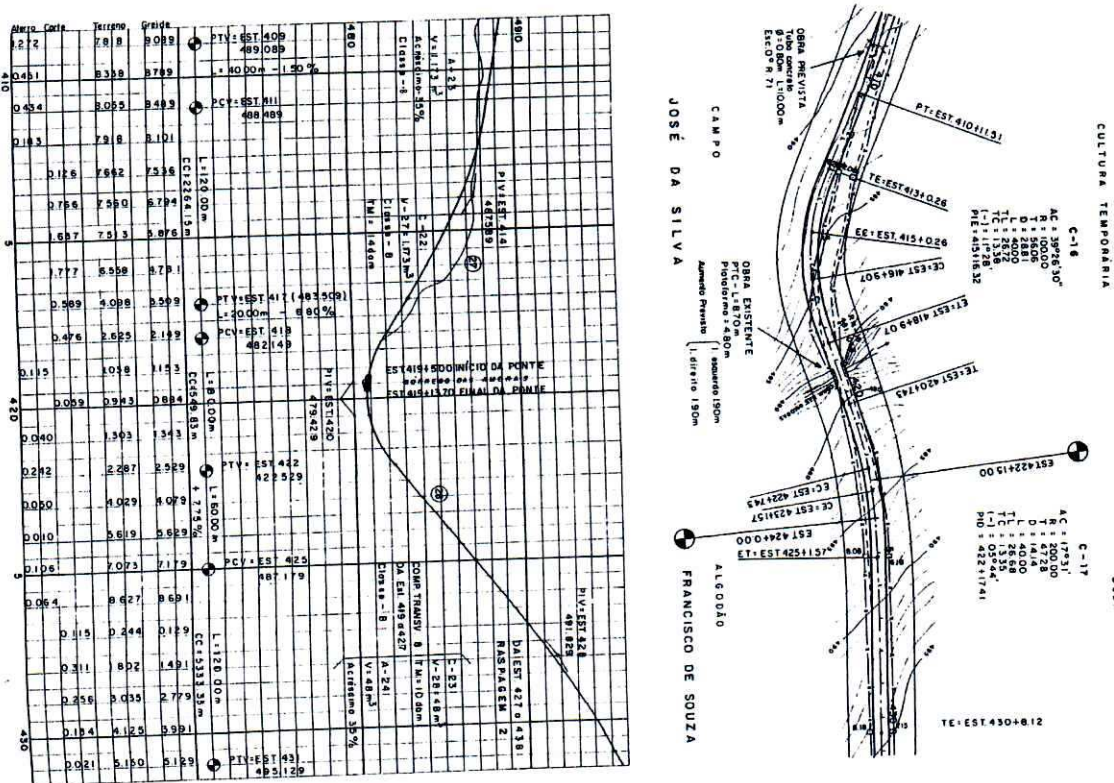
Planta e perfil longitudinal de uma estrada
